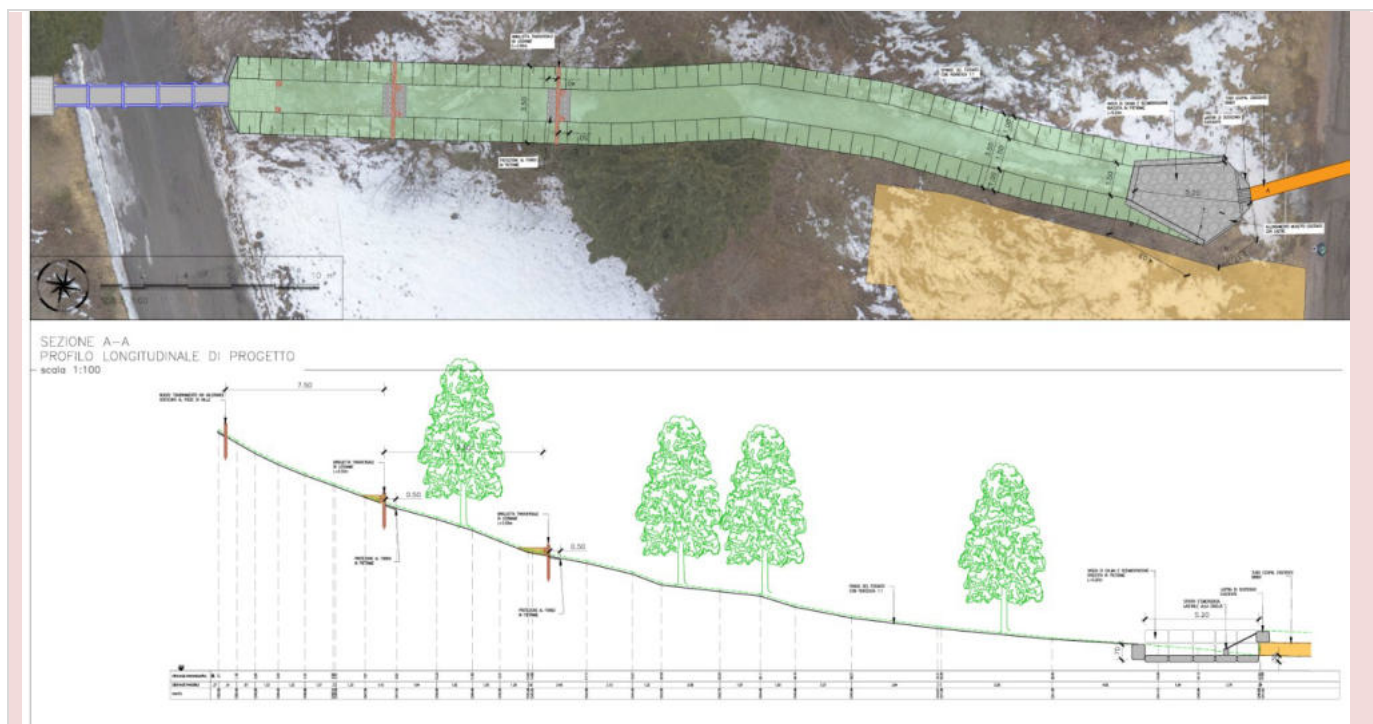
Planimetria e profilo della riprofilatura del rio posto tra i due attraversamenti
